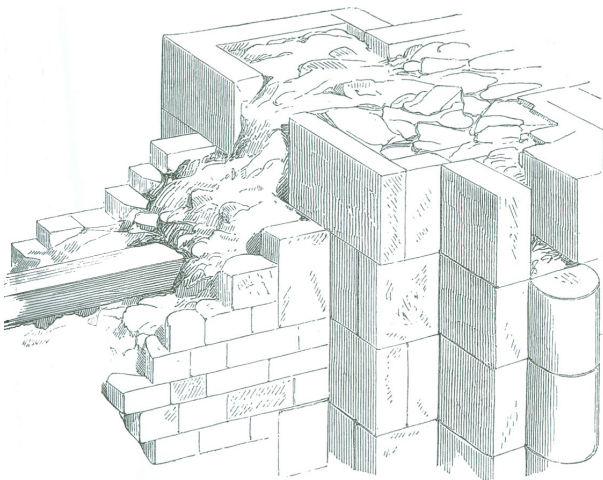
Reconstrucción de la sección de un muro por Viollet Le Duc
